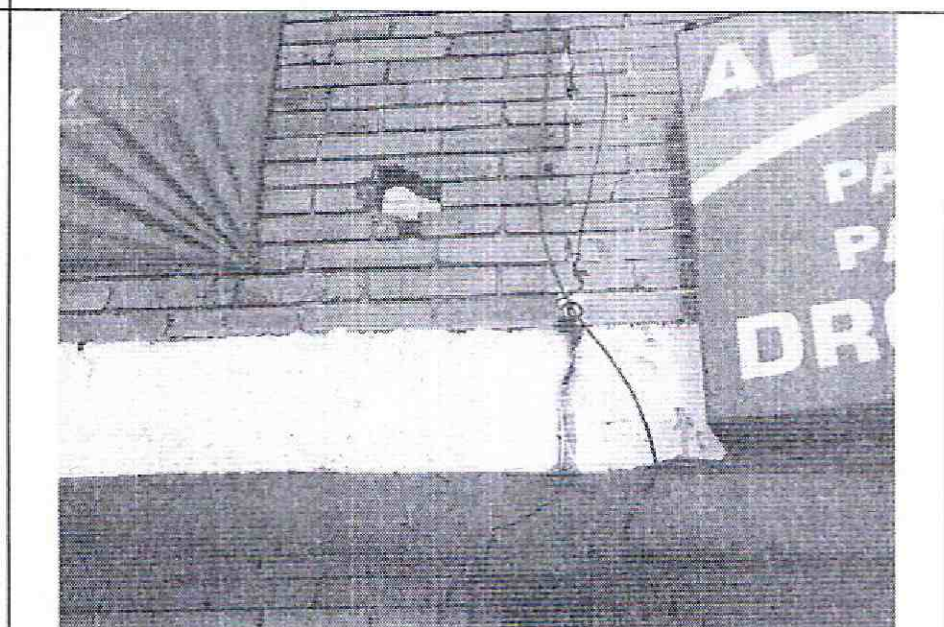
Detalle muro de fachada segundo piso. Agrietamiento perceptible de unidades de mampostería
